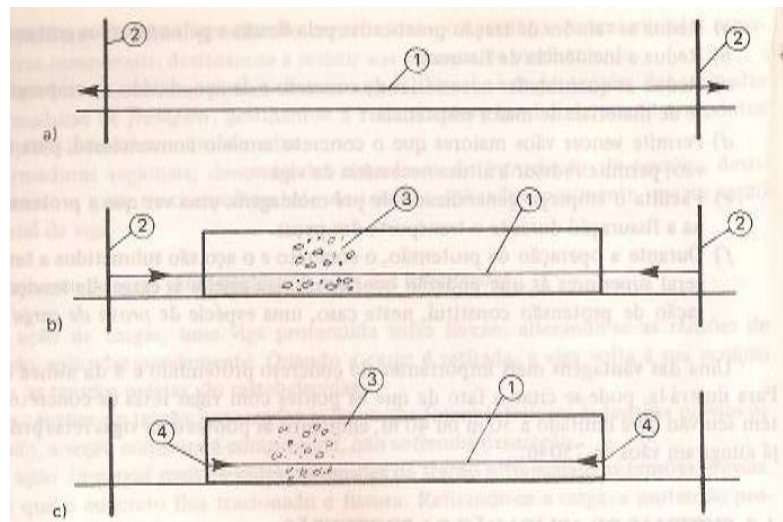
Sequência construtiva de vigas com armaduras pré-tensionadas.
